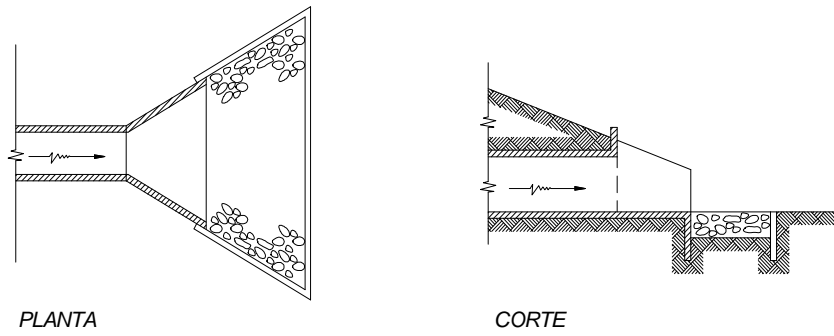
TERMINAL DE ALCANTARILLA CON BATEA DE HORMIGON
